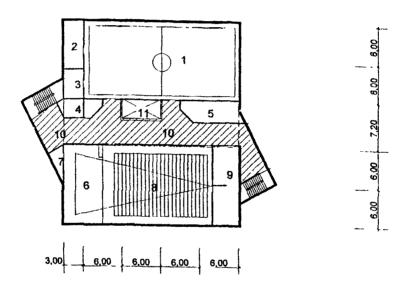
Схема архитектурно-планировочного решения блока общешкольных помещений с залами и кружковыми «БОП-3»
